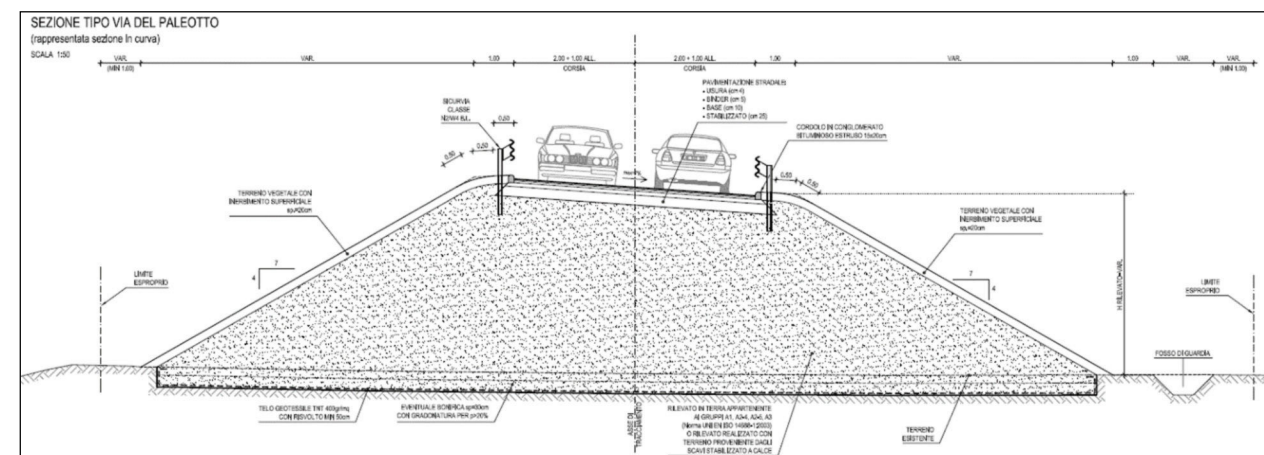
Sezione trasversale tipica del collegamento a via del Paleotto
